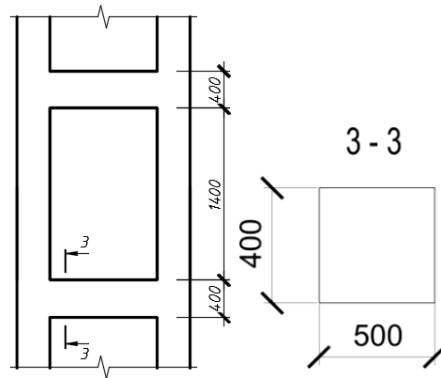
Загальний вигляд розпірки двогілкової колони
